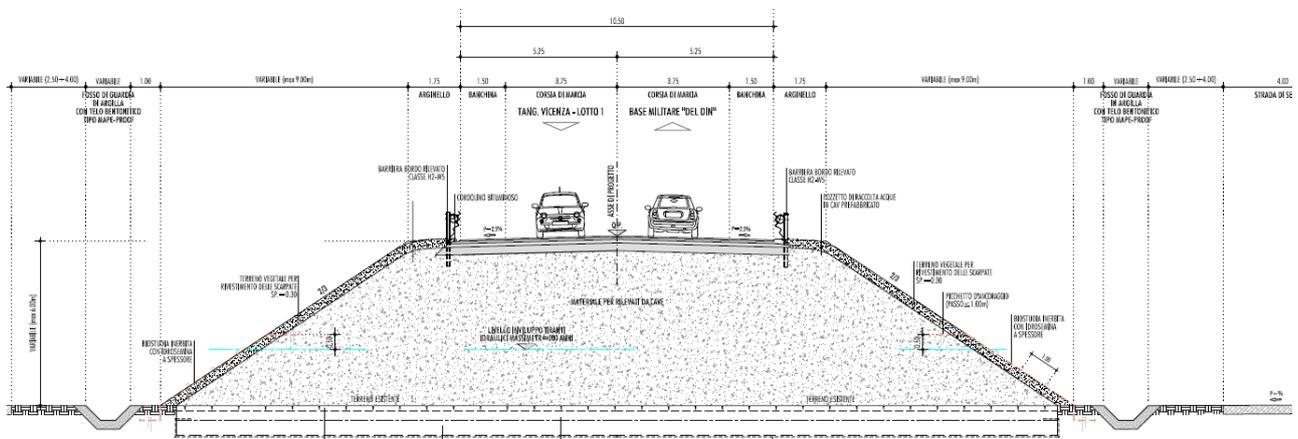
SEZIONE TIPO IN RILEVATO
